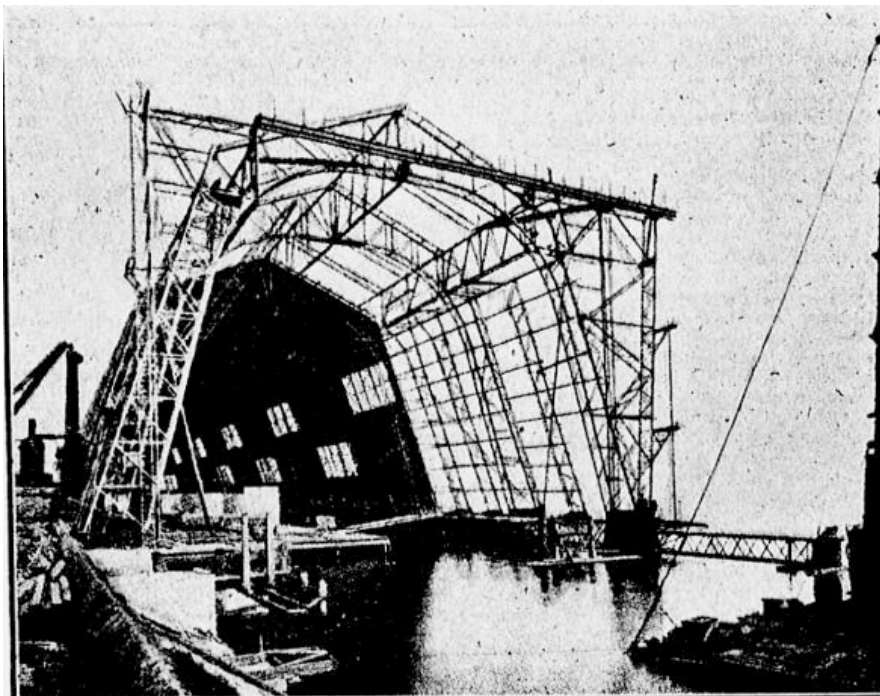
Hangar à dirigeable, structure en fer cornière et plat de Barrow, 1911
